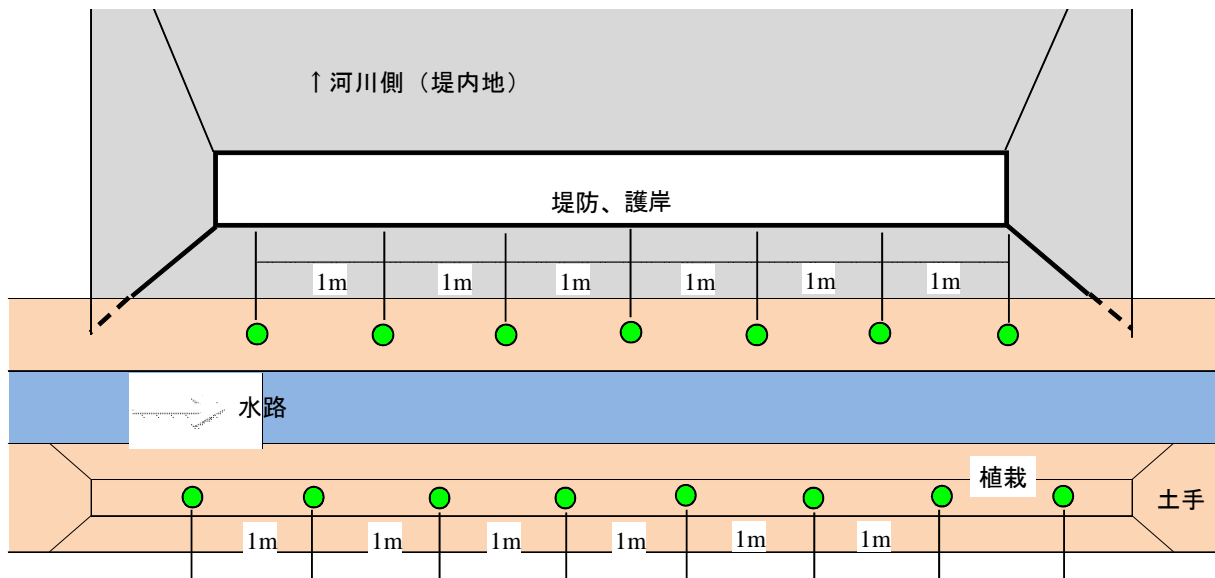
河川構造物沿いの植林計画標準配置図 (タイプ B)
